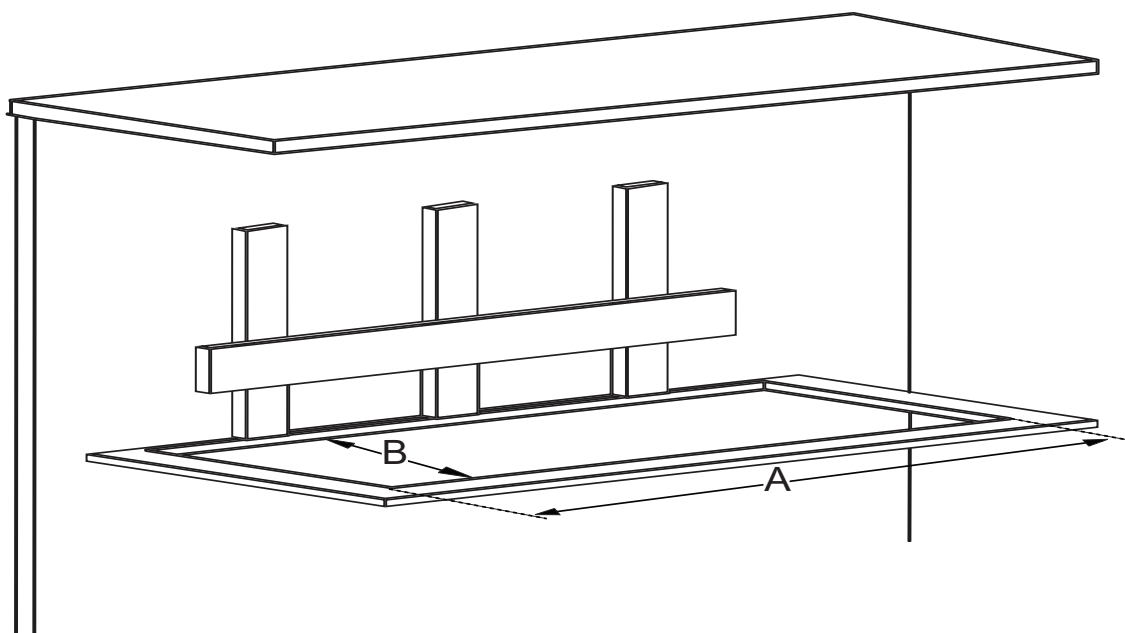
Dimensions des ouvertures pour le raccord et le tube protecteur
